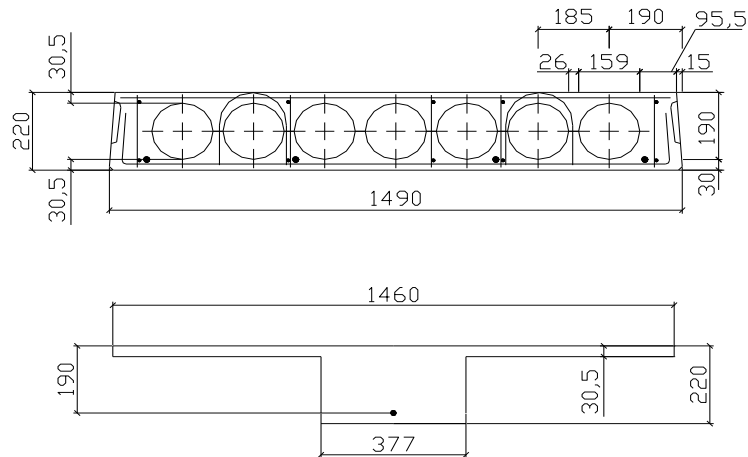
Розрахунок плити перекриття за граничними станами першої групи
